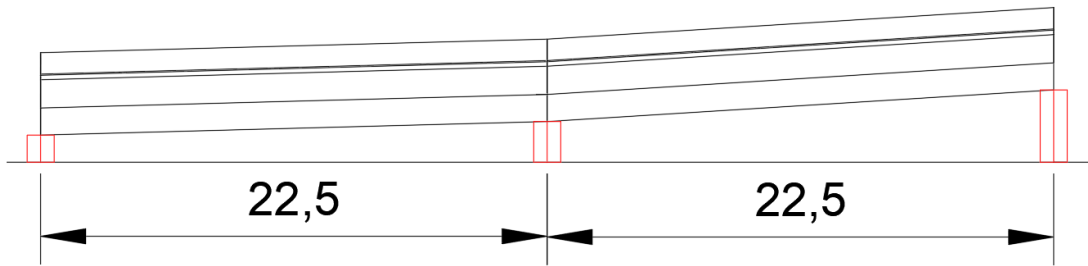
De izquierda a derecha pila #1, pila #2 y pila #3 presentes en el tramo 1; Unidades en metros. Fuente: Elaboración propia de autor
